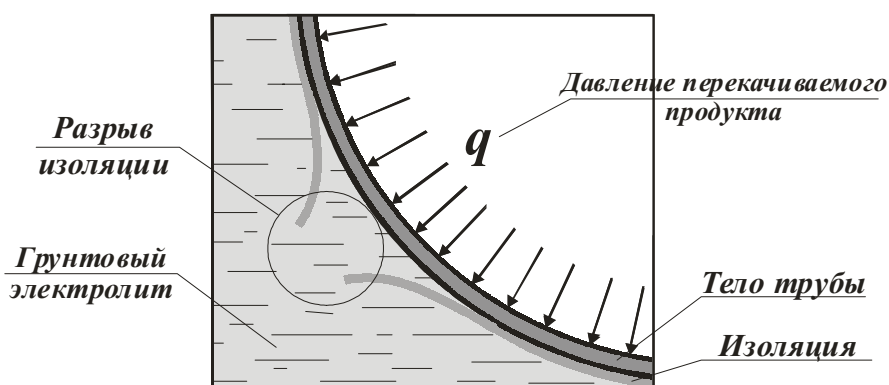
Нарушение адгезии изоляционного покрытия трубопровода.
